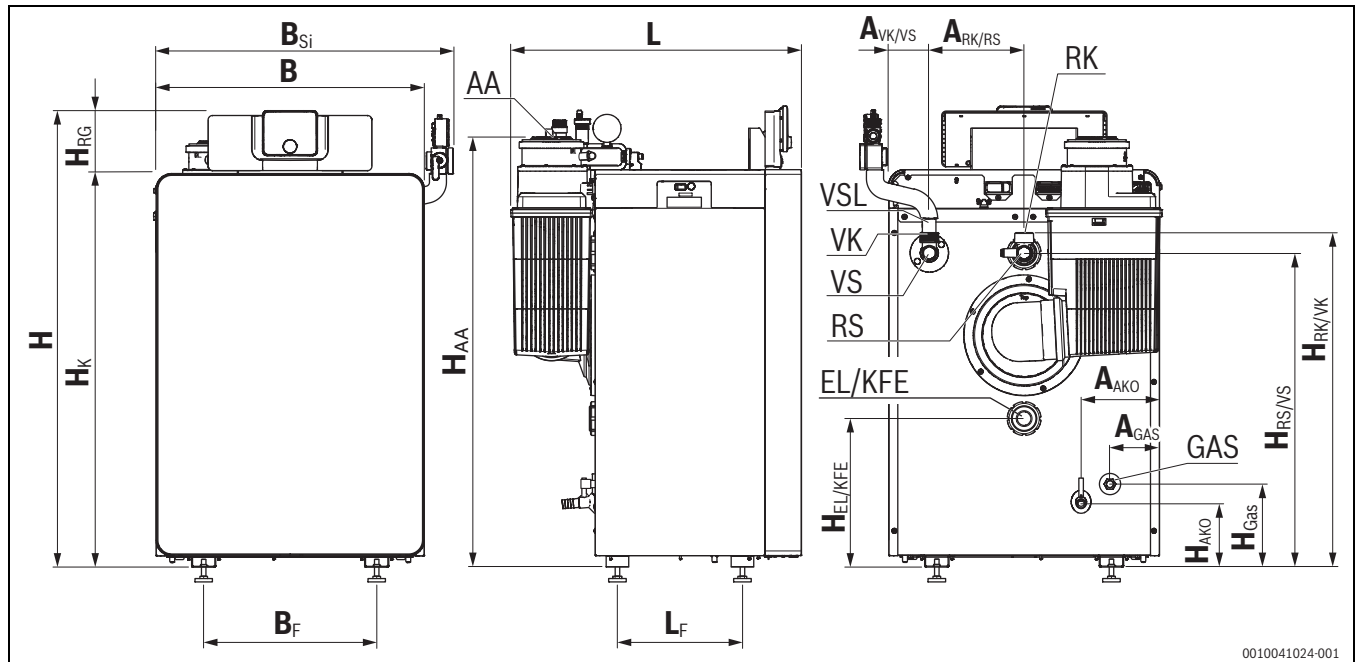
Abmessungen und Anschlüsse für OC8000iF/M-22 Gas (Maße in mm)
